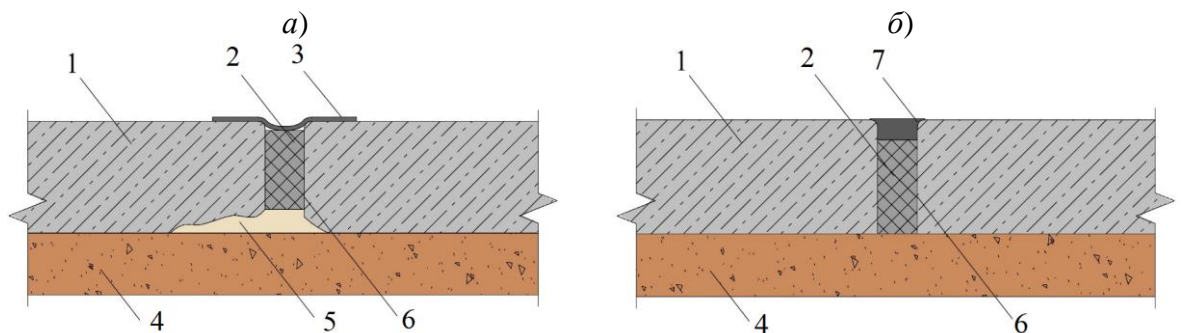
Способ ремонта крупных повреждений бетонной облицовки по дну (узел А) и на откосе (узел Б)
